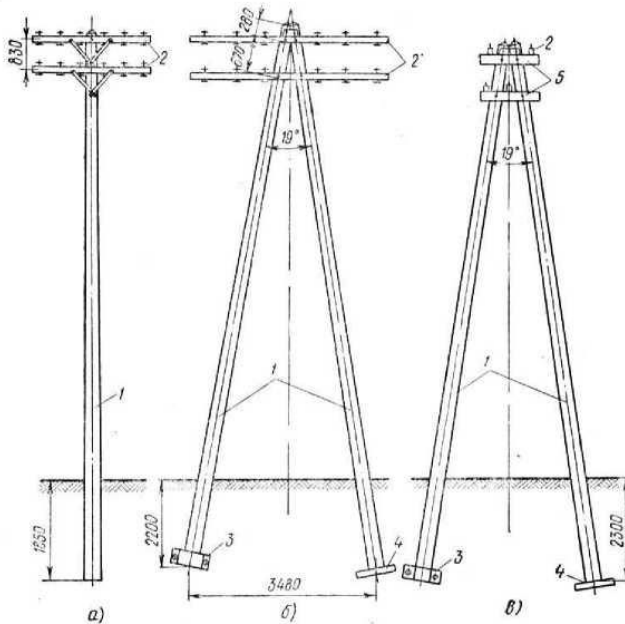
Железобетонные опоры ВЛ до 1000 вольт:
